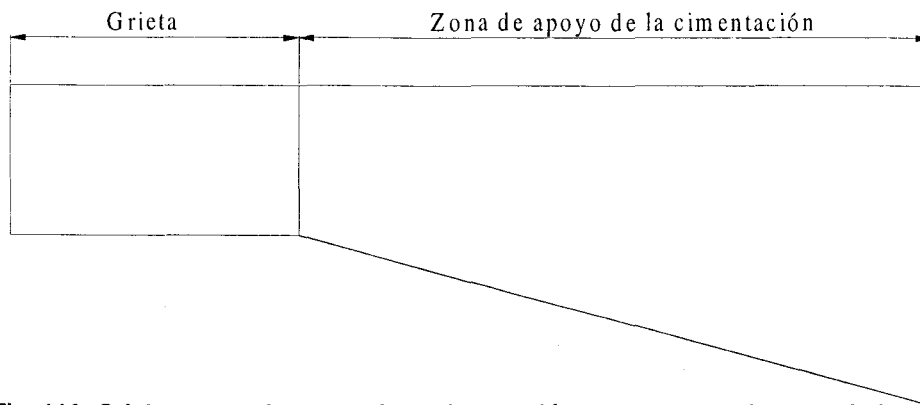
Grieta y zona de apoyo de la cimentación en una presa de gravedad
